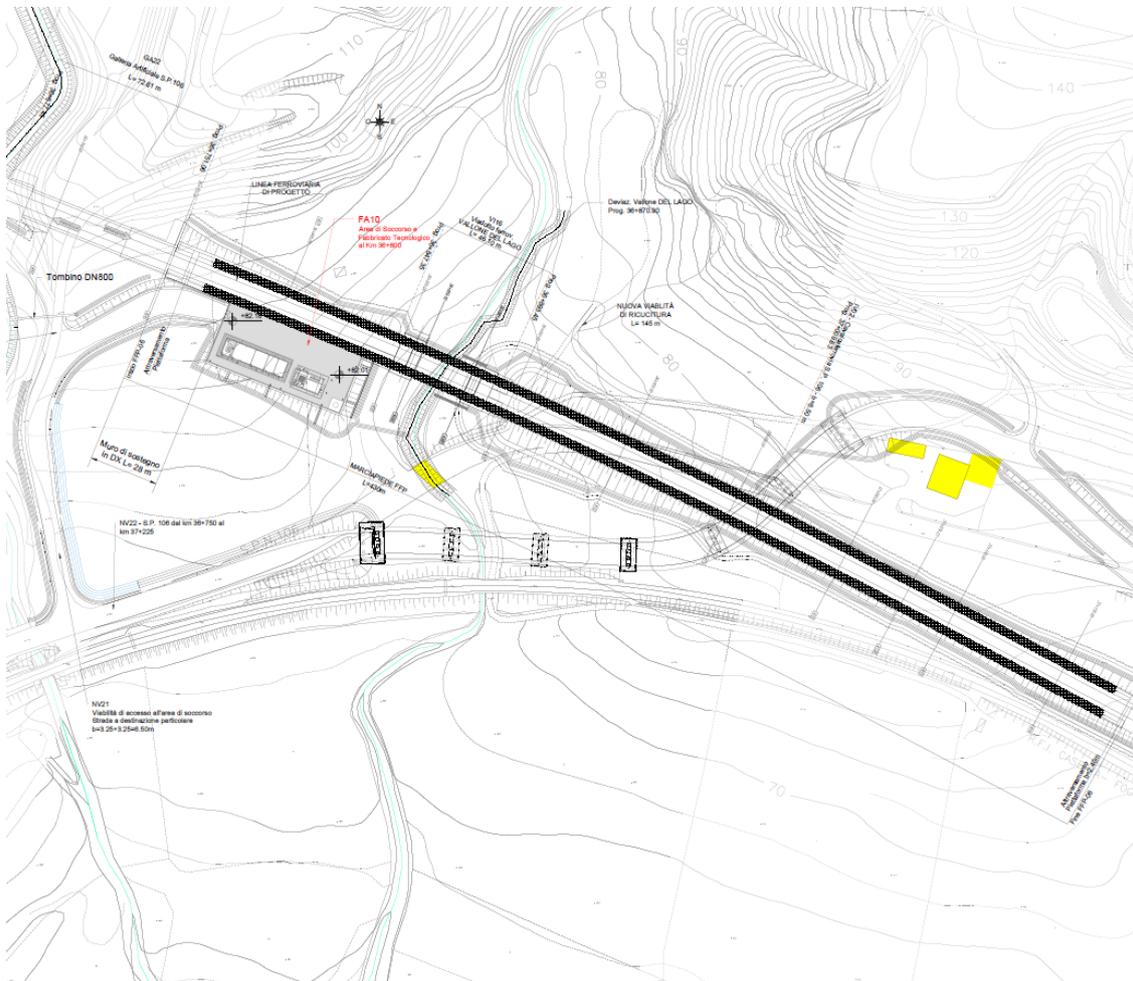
Planimetria generale_FA10 – pk. 36+800
